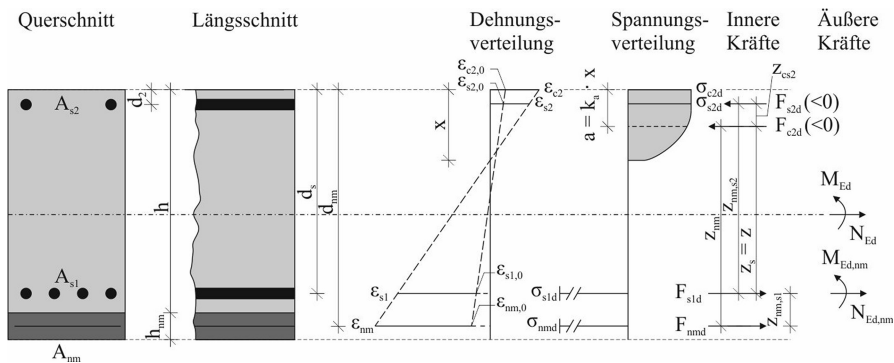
Querschnitt eines mit Carbonbeton verstärkten Bauteils mit Dehnungs- und Spannungsverteilung inklusive der Darstellung der inneren und äußeren Kräfte (Variante I, bezogen auf die Schwerachse der Betonstahlbewehrung), in Anlehnung an [141].
